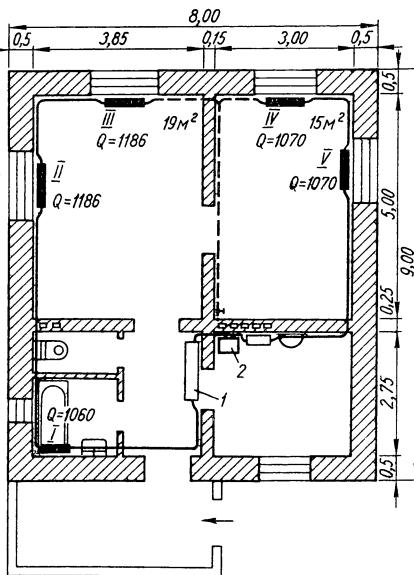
План квартиры с расположением нагревательных приборов, котла и трубопроводов:
